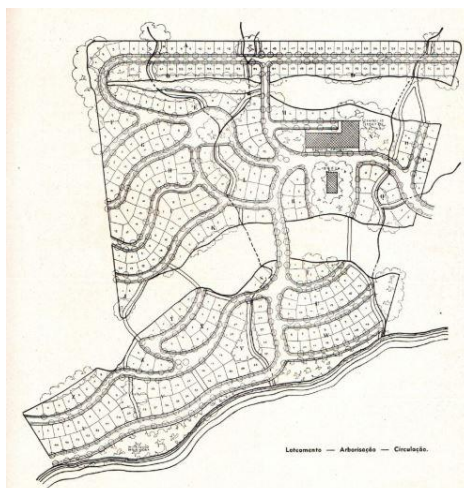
Planta baixa do projeto para a Cidade Operária de Monlevade, Murgel, 1936
